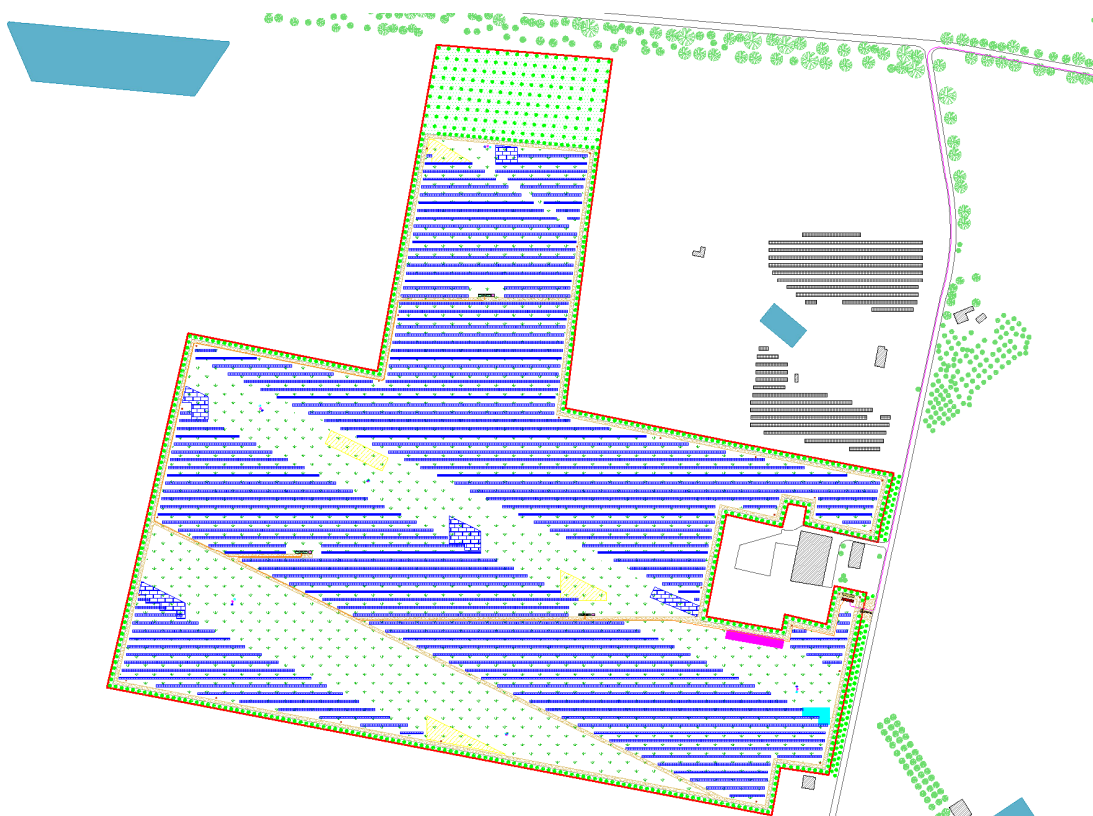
Piano di cantierizzazione con individuazione dei punti di stoccaggio e delle aree di cantiere sul Plot 2 (Tavola D25)
